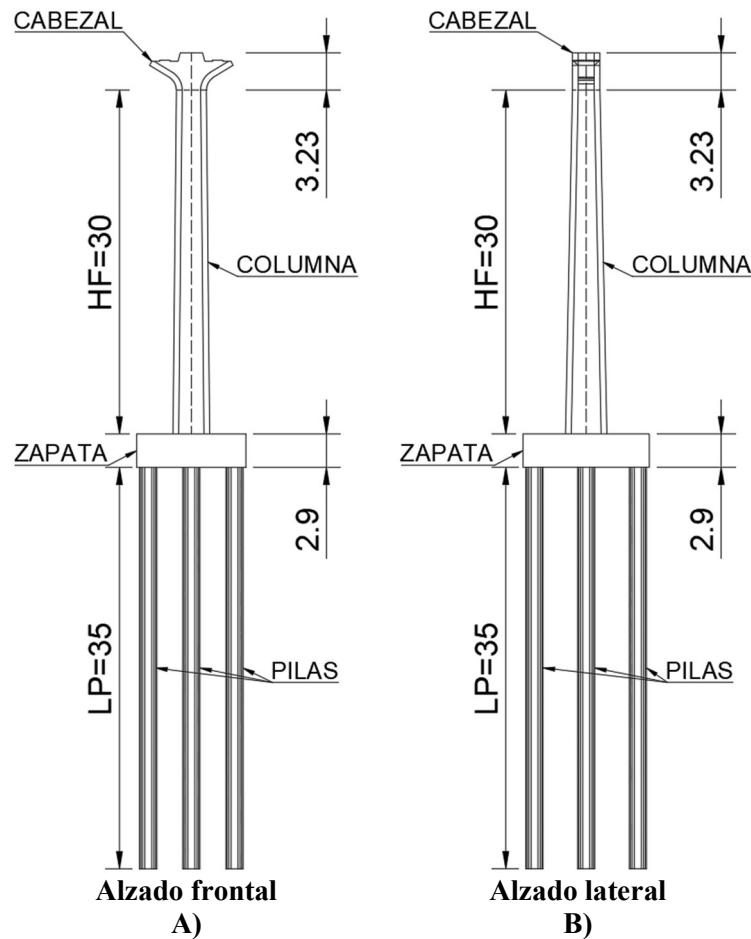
Alzados del apoyo con cimentación, con dimensiones y elementos generales
